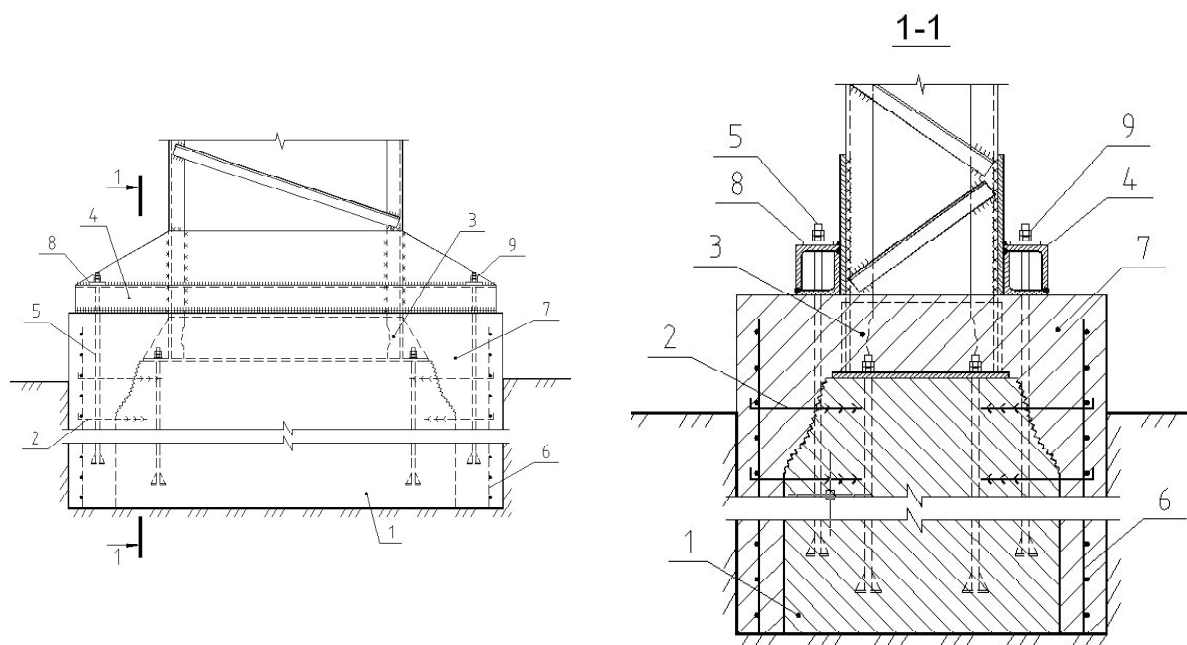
Усиление элементов нижних панелей опор и узла опирания конструкции на фундамент по средствам развития базы: 1 — существующий фундамент; 2 — анкерующие коротыши; 3 — прокорродировавшие участки базы; 4 — элементы новой базы; 5 — новые анкерные болты; 6 — арматурная сетка; 7 — новый фундамент; 8 — шайбы; 9 — гайки.
